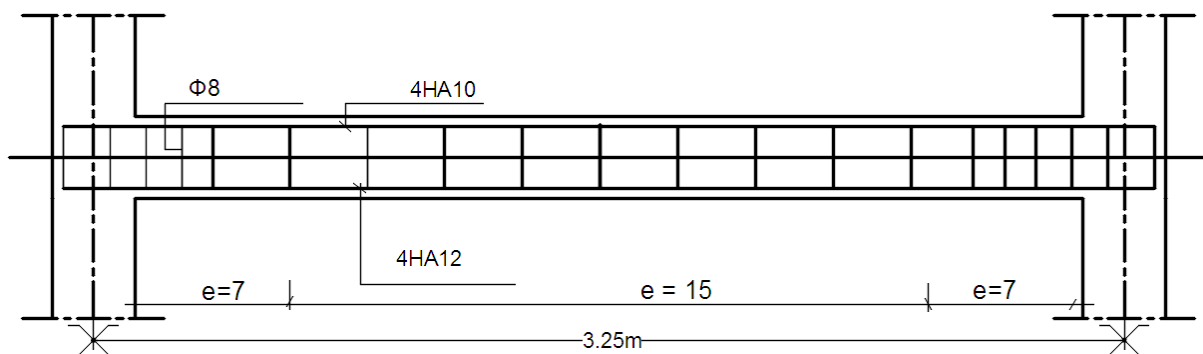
4 : Plan de ferrailage de la poutre palière.
